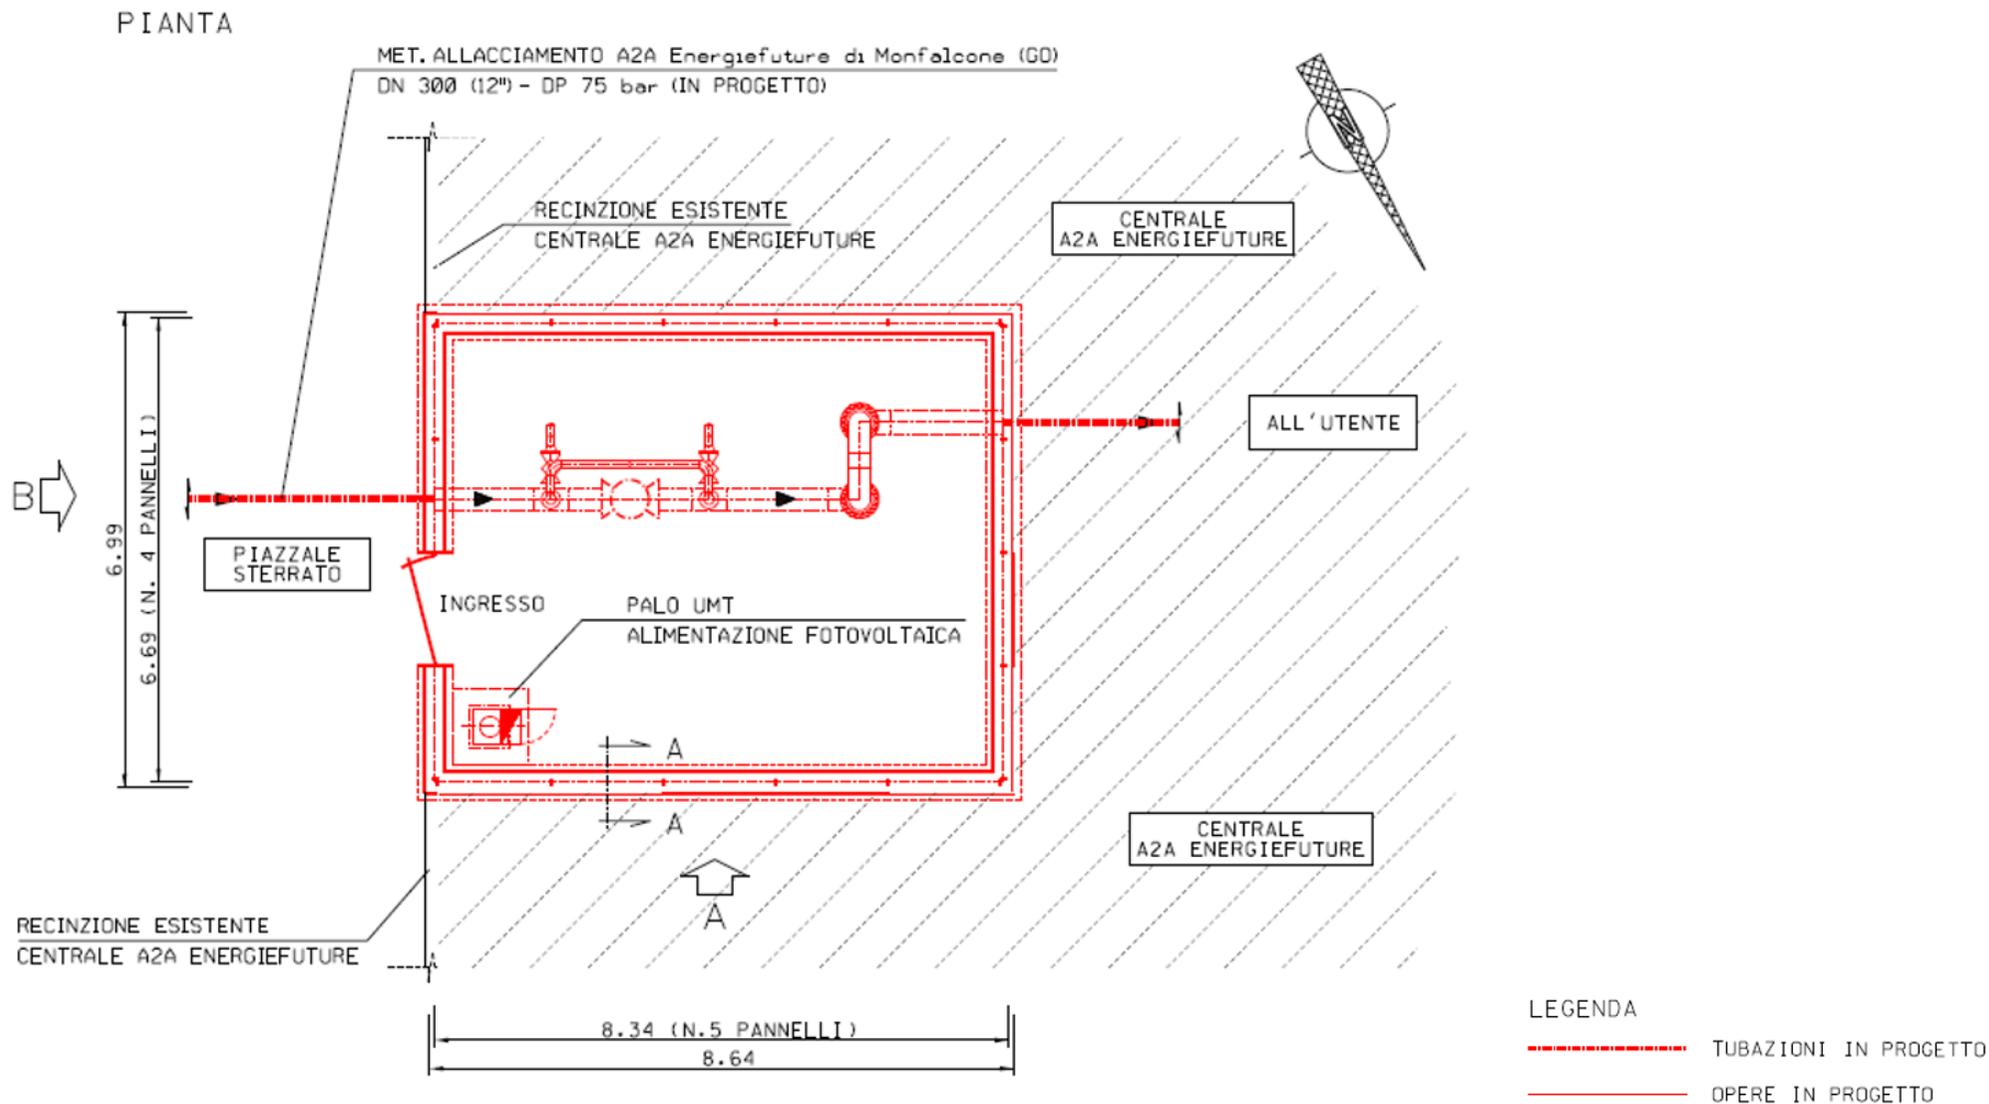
Planimetria del nuovo punto di intercettazione con discaggio di allacciamento n.3 (P.I.D.A. n.3)
